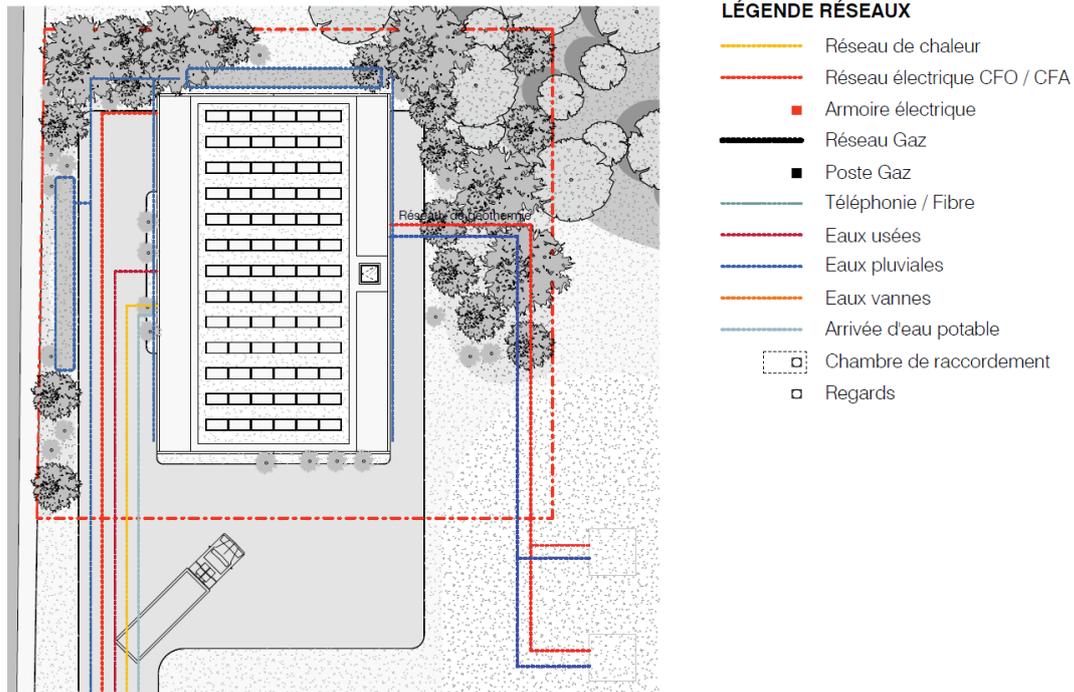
Plan des futurs réseaux enterrés sur la zone centrale
